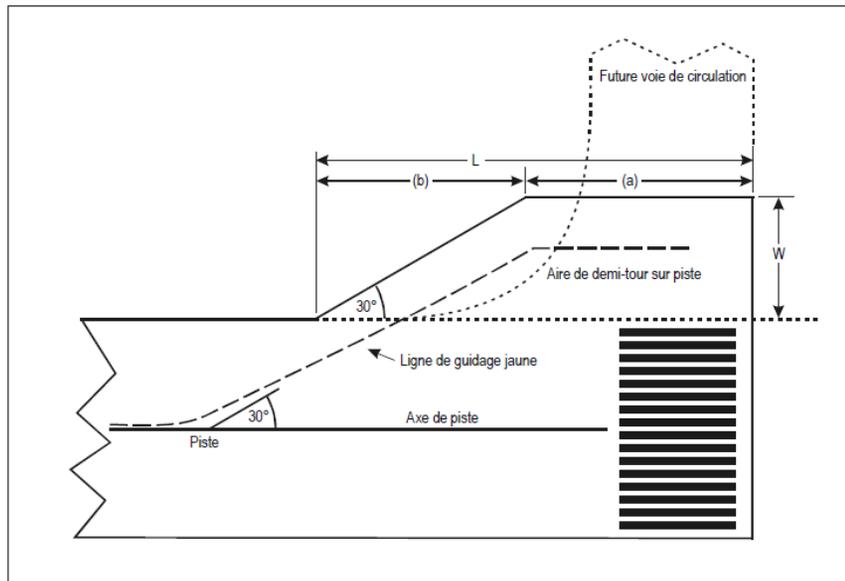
Plan type OACI d'une aire de demi-tour sur piste.
